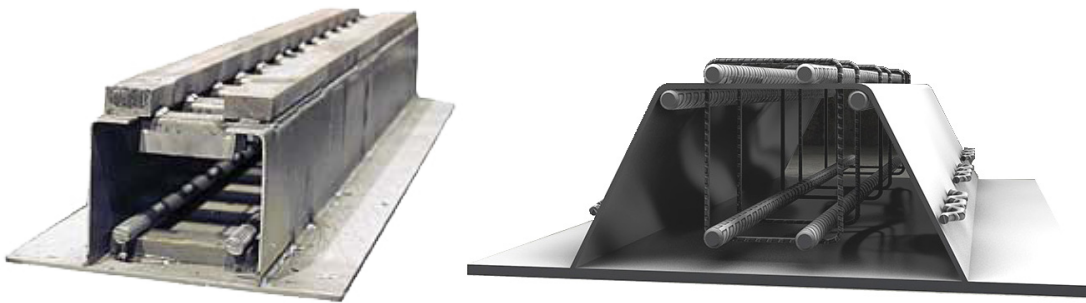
Примеры сечений сталежелезобетонных балок, преобладающих на рынках Скандинавских стран
